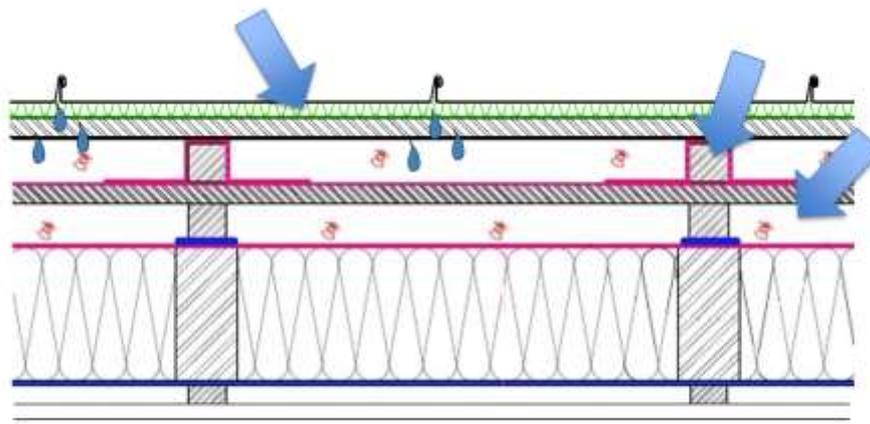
Холодные кровли с углами наклона не менее 7 град.
